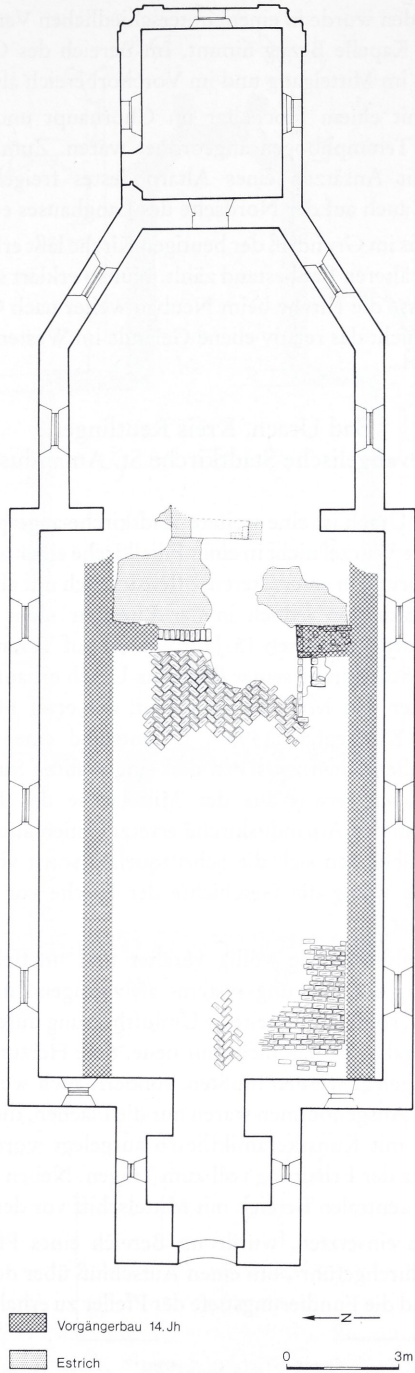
Winterstettenstadt, Gde. Ingoldingen, Kreis Biberach. Grundriß der katholischen Pfarrkirche mit Vorgängerbau.
